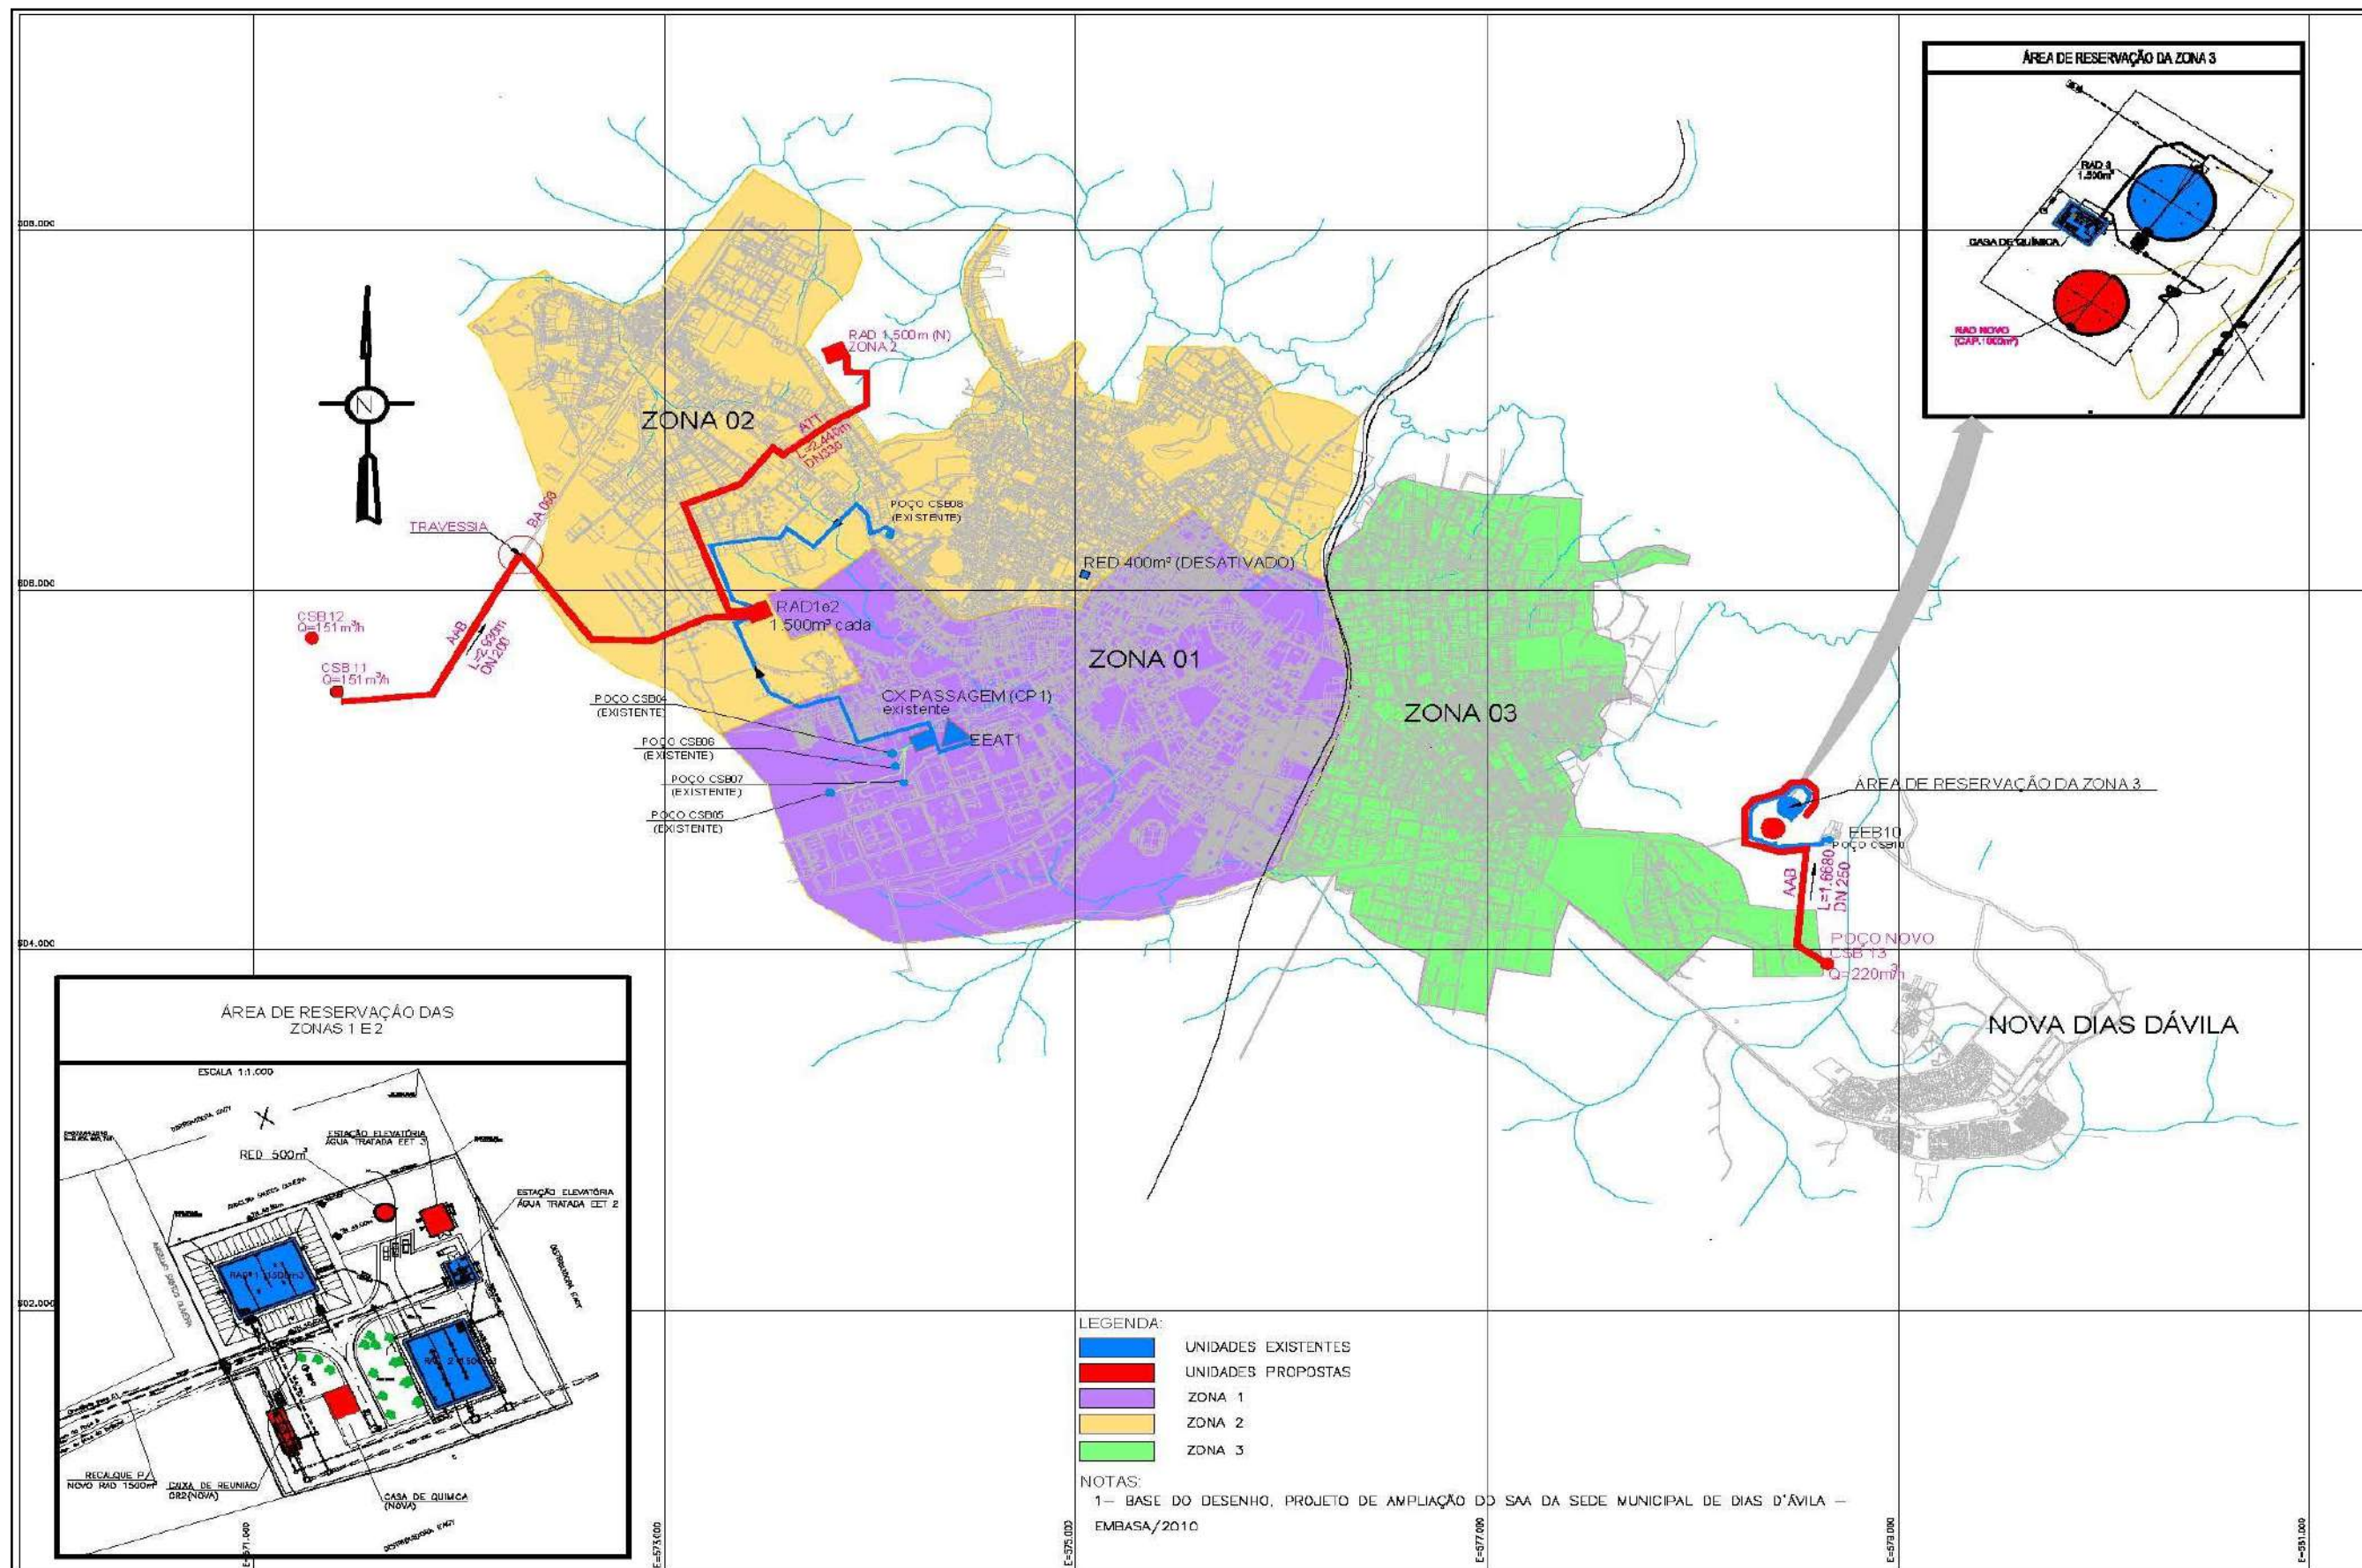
Planta geral do Sistema Proposto SAA Sede Municipal.
